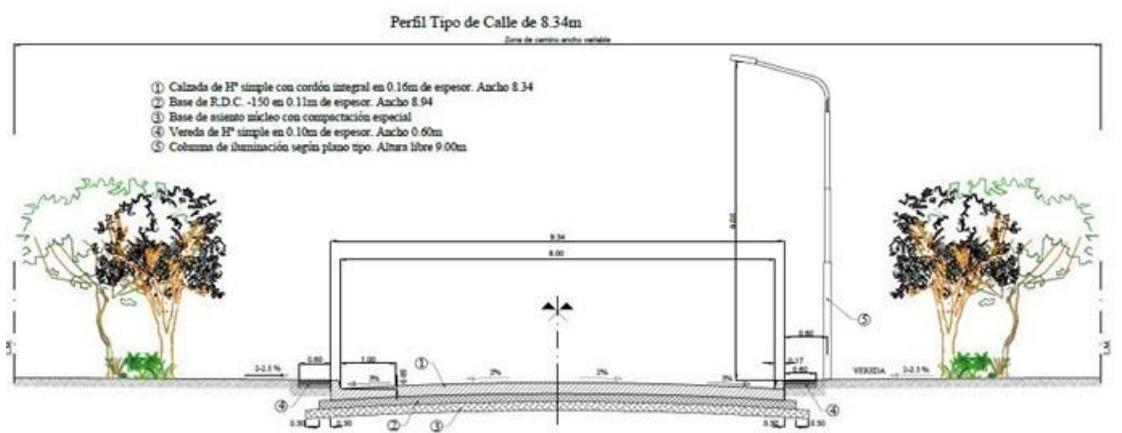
Perfil de Obra tipo Calle -Fuente: Informe de Ingeniería.
